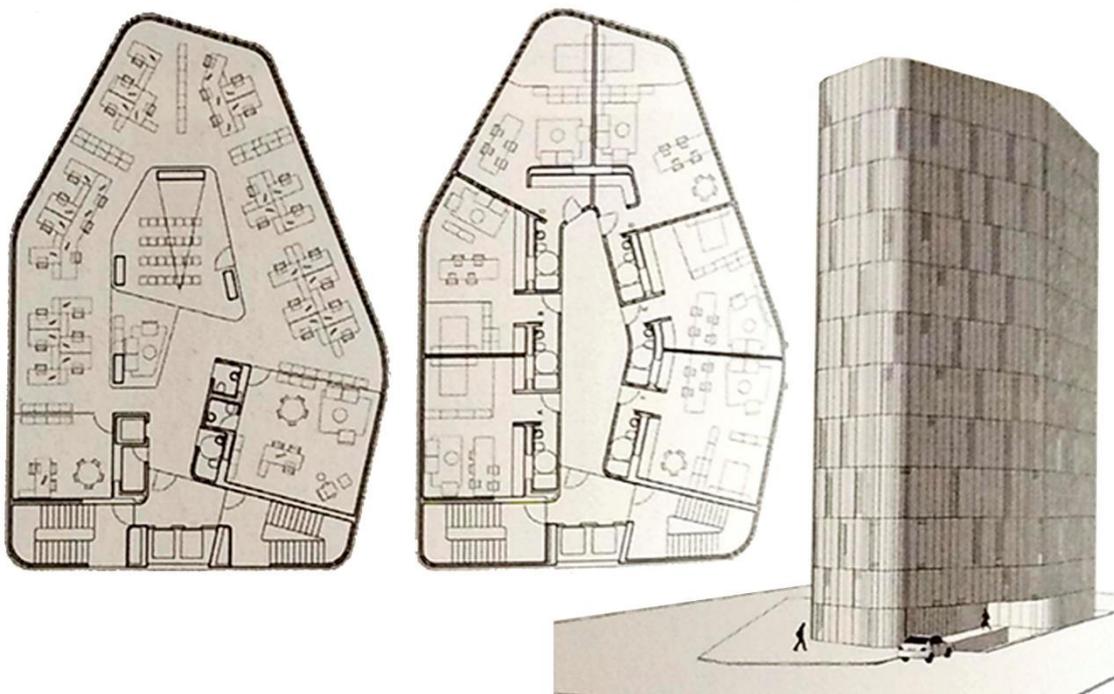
Planta tipo oficinas, planta tipo viviendas y volumetría general.
